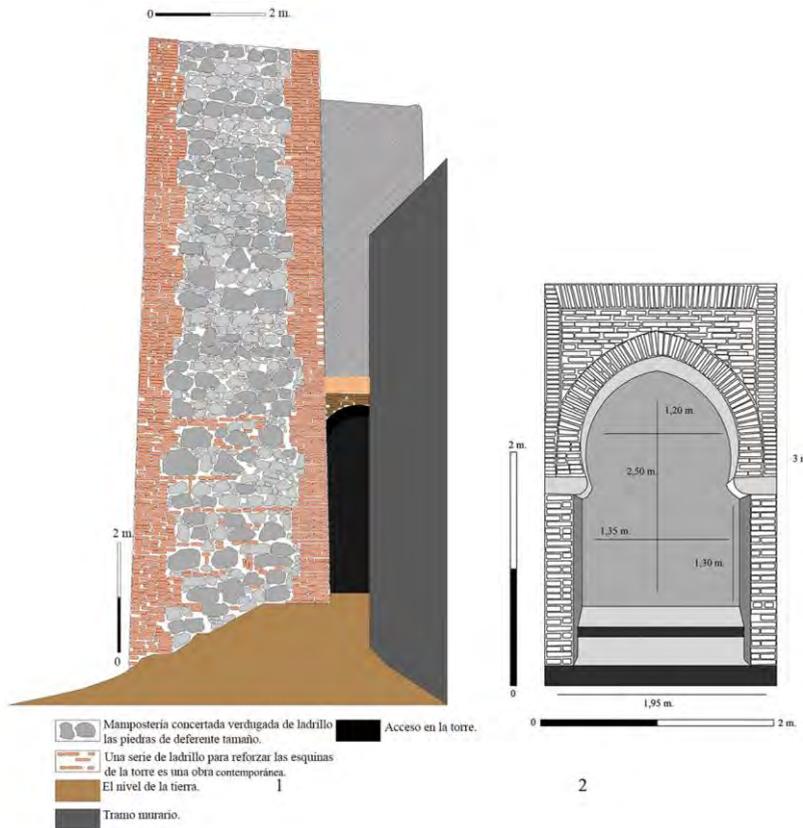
La puerta del Sol en su cara noreste. 1- La técnica constructiva, mampostería concertada de piedras de diferente tamaño y verdugada con ladrillo y piedras, con refuerzo de ladrillo en sus esquinas. 2- El acceso a la puerta.
